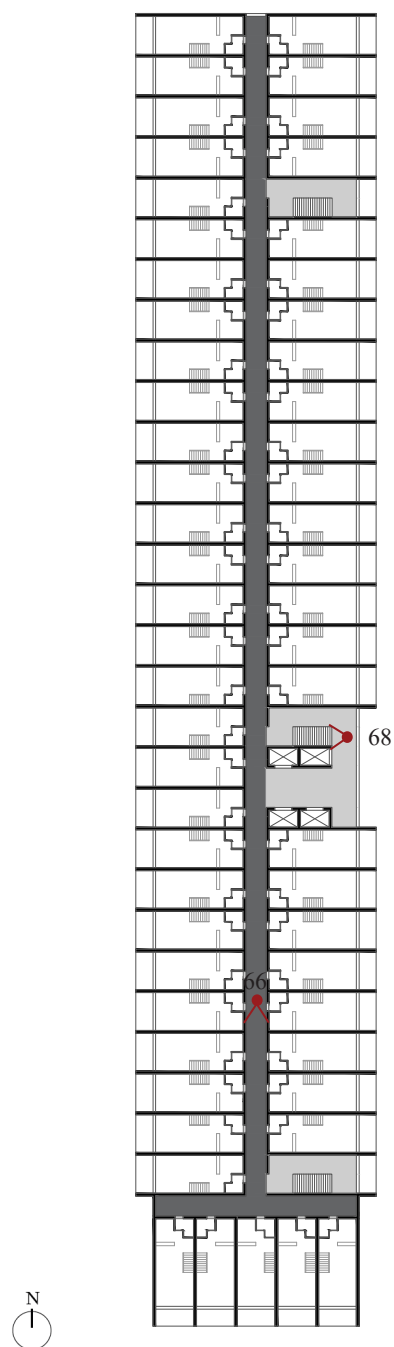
Planta piso-tipo. Escala 1:1000.
